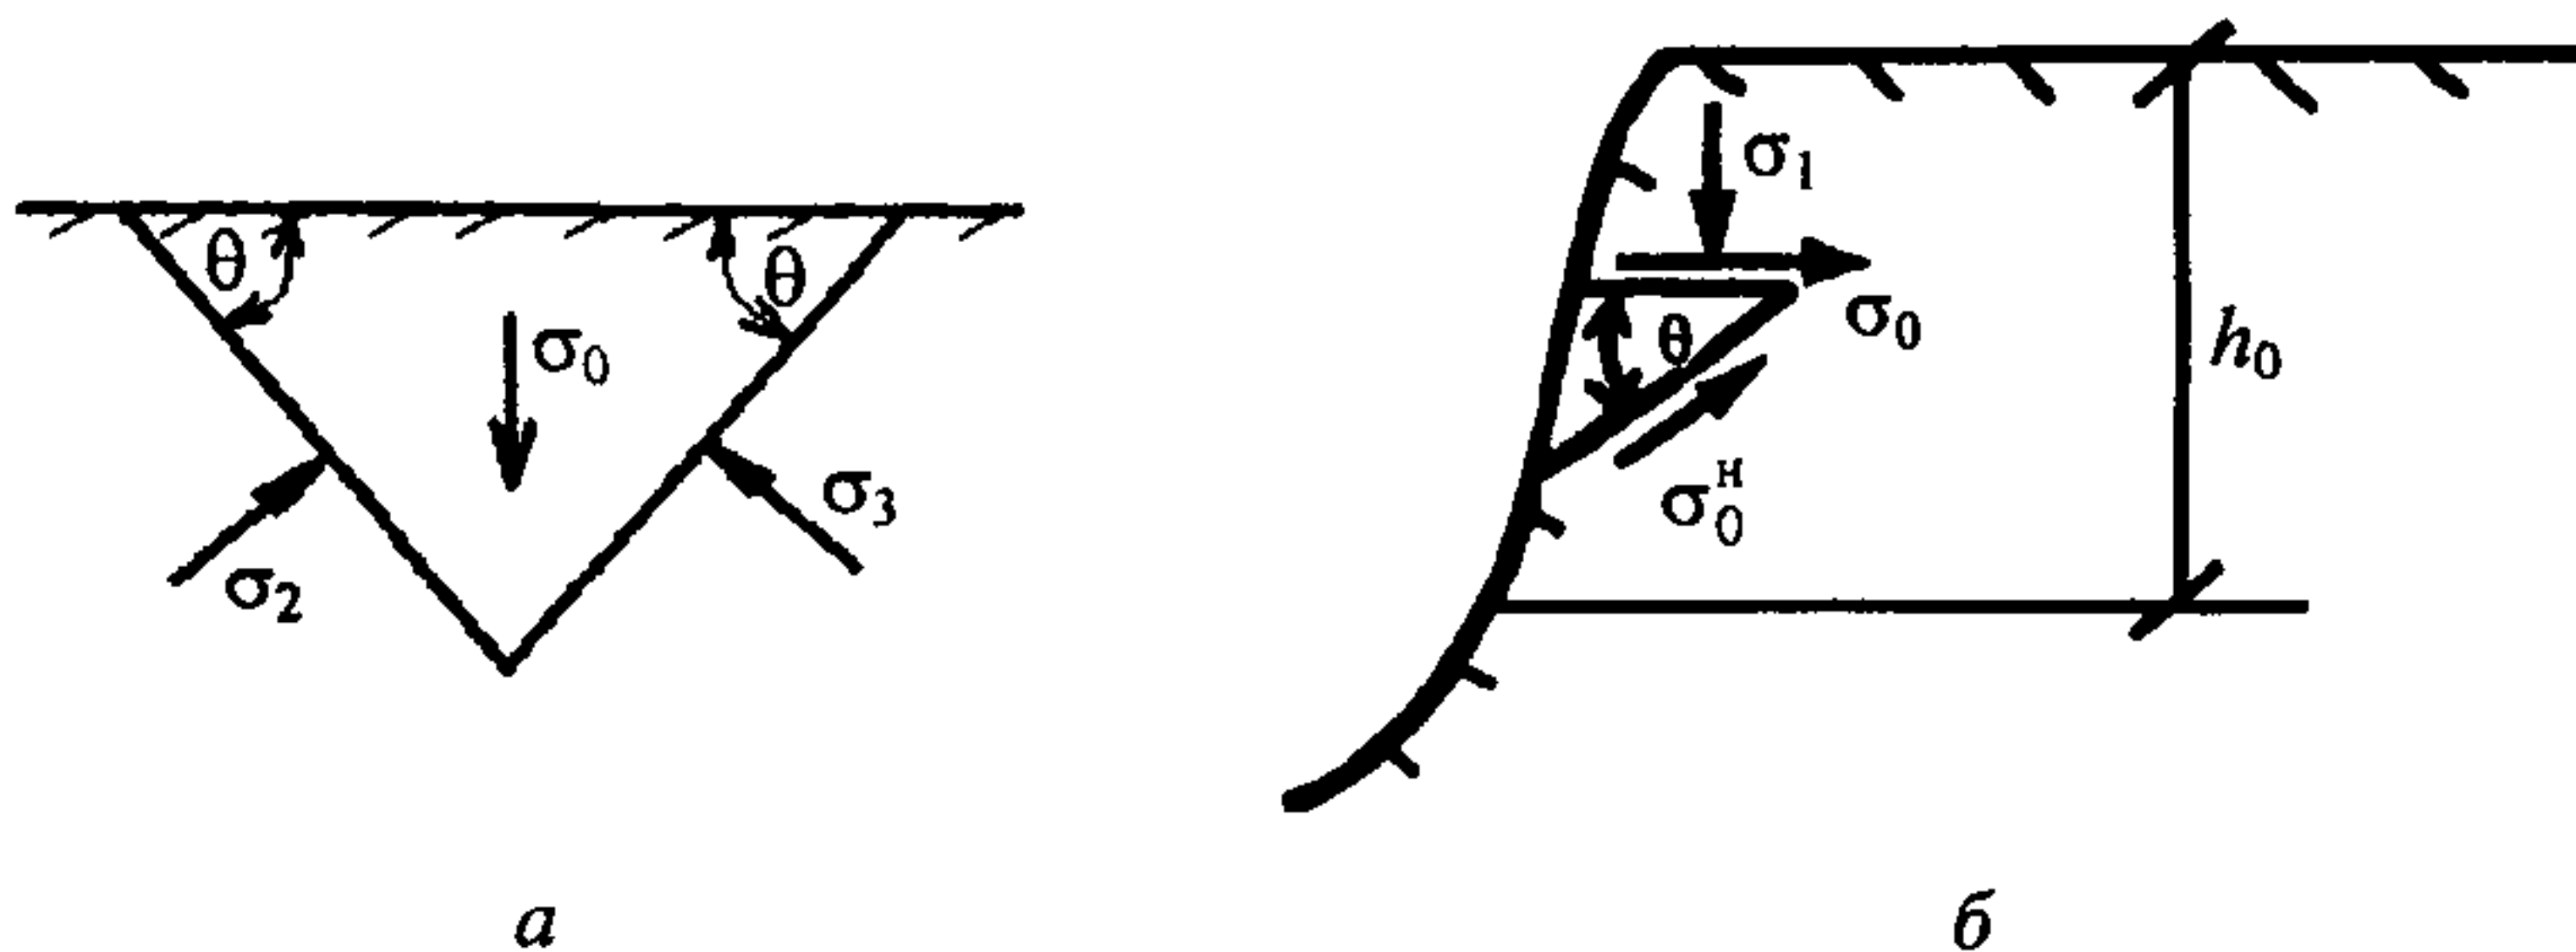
Схема к расчету вертикального обрыва: а – план; б – разрез
